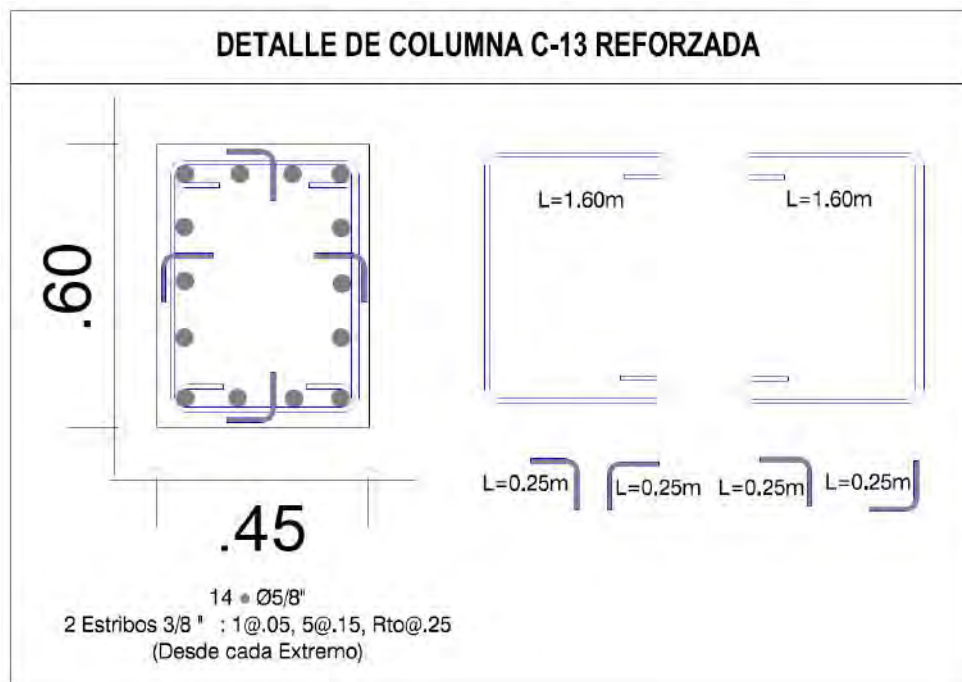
Detalle de la sección C-13 reforzada con encamisado de concreto armado
